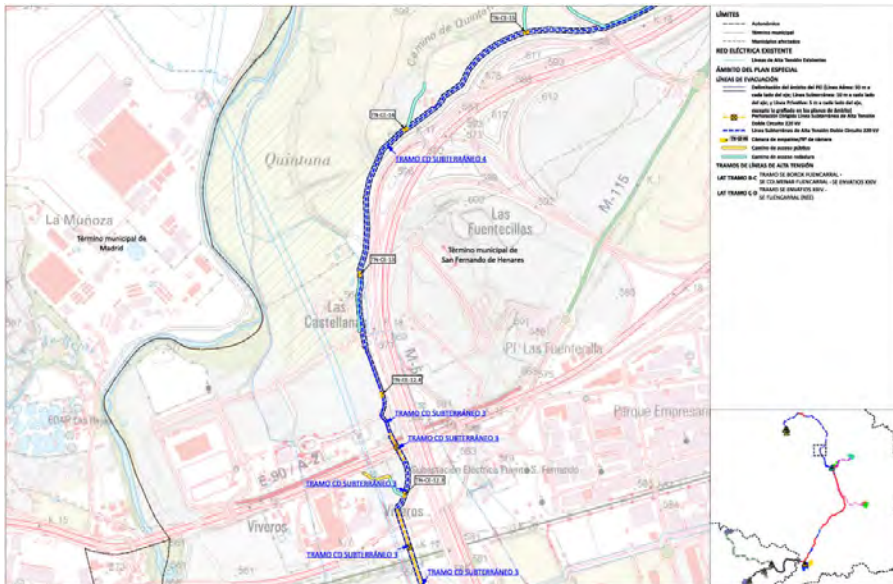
Plano de Ordenación O2.5.4. Planta por tramos. LASAT Promotores Nudo Fuencarral Tramo C-D
